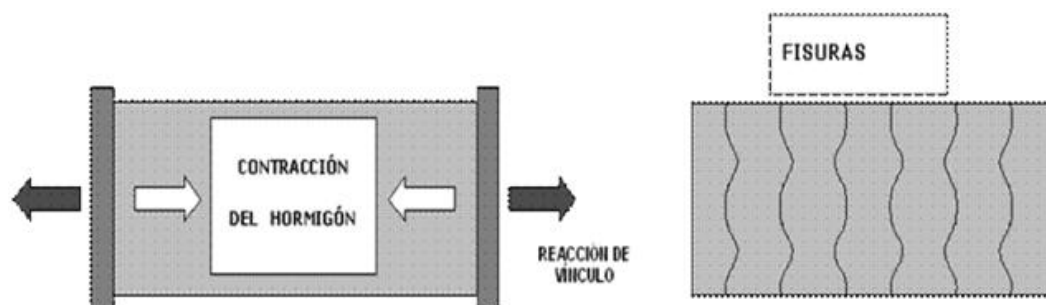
Fisuración por efecto de la contracción impedida.
